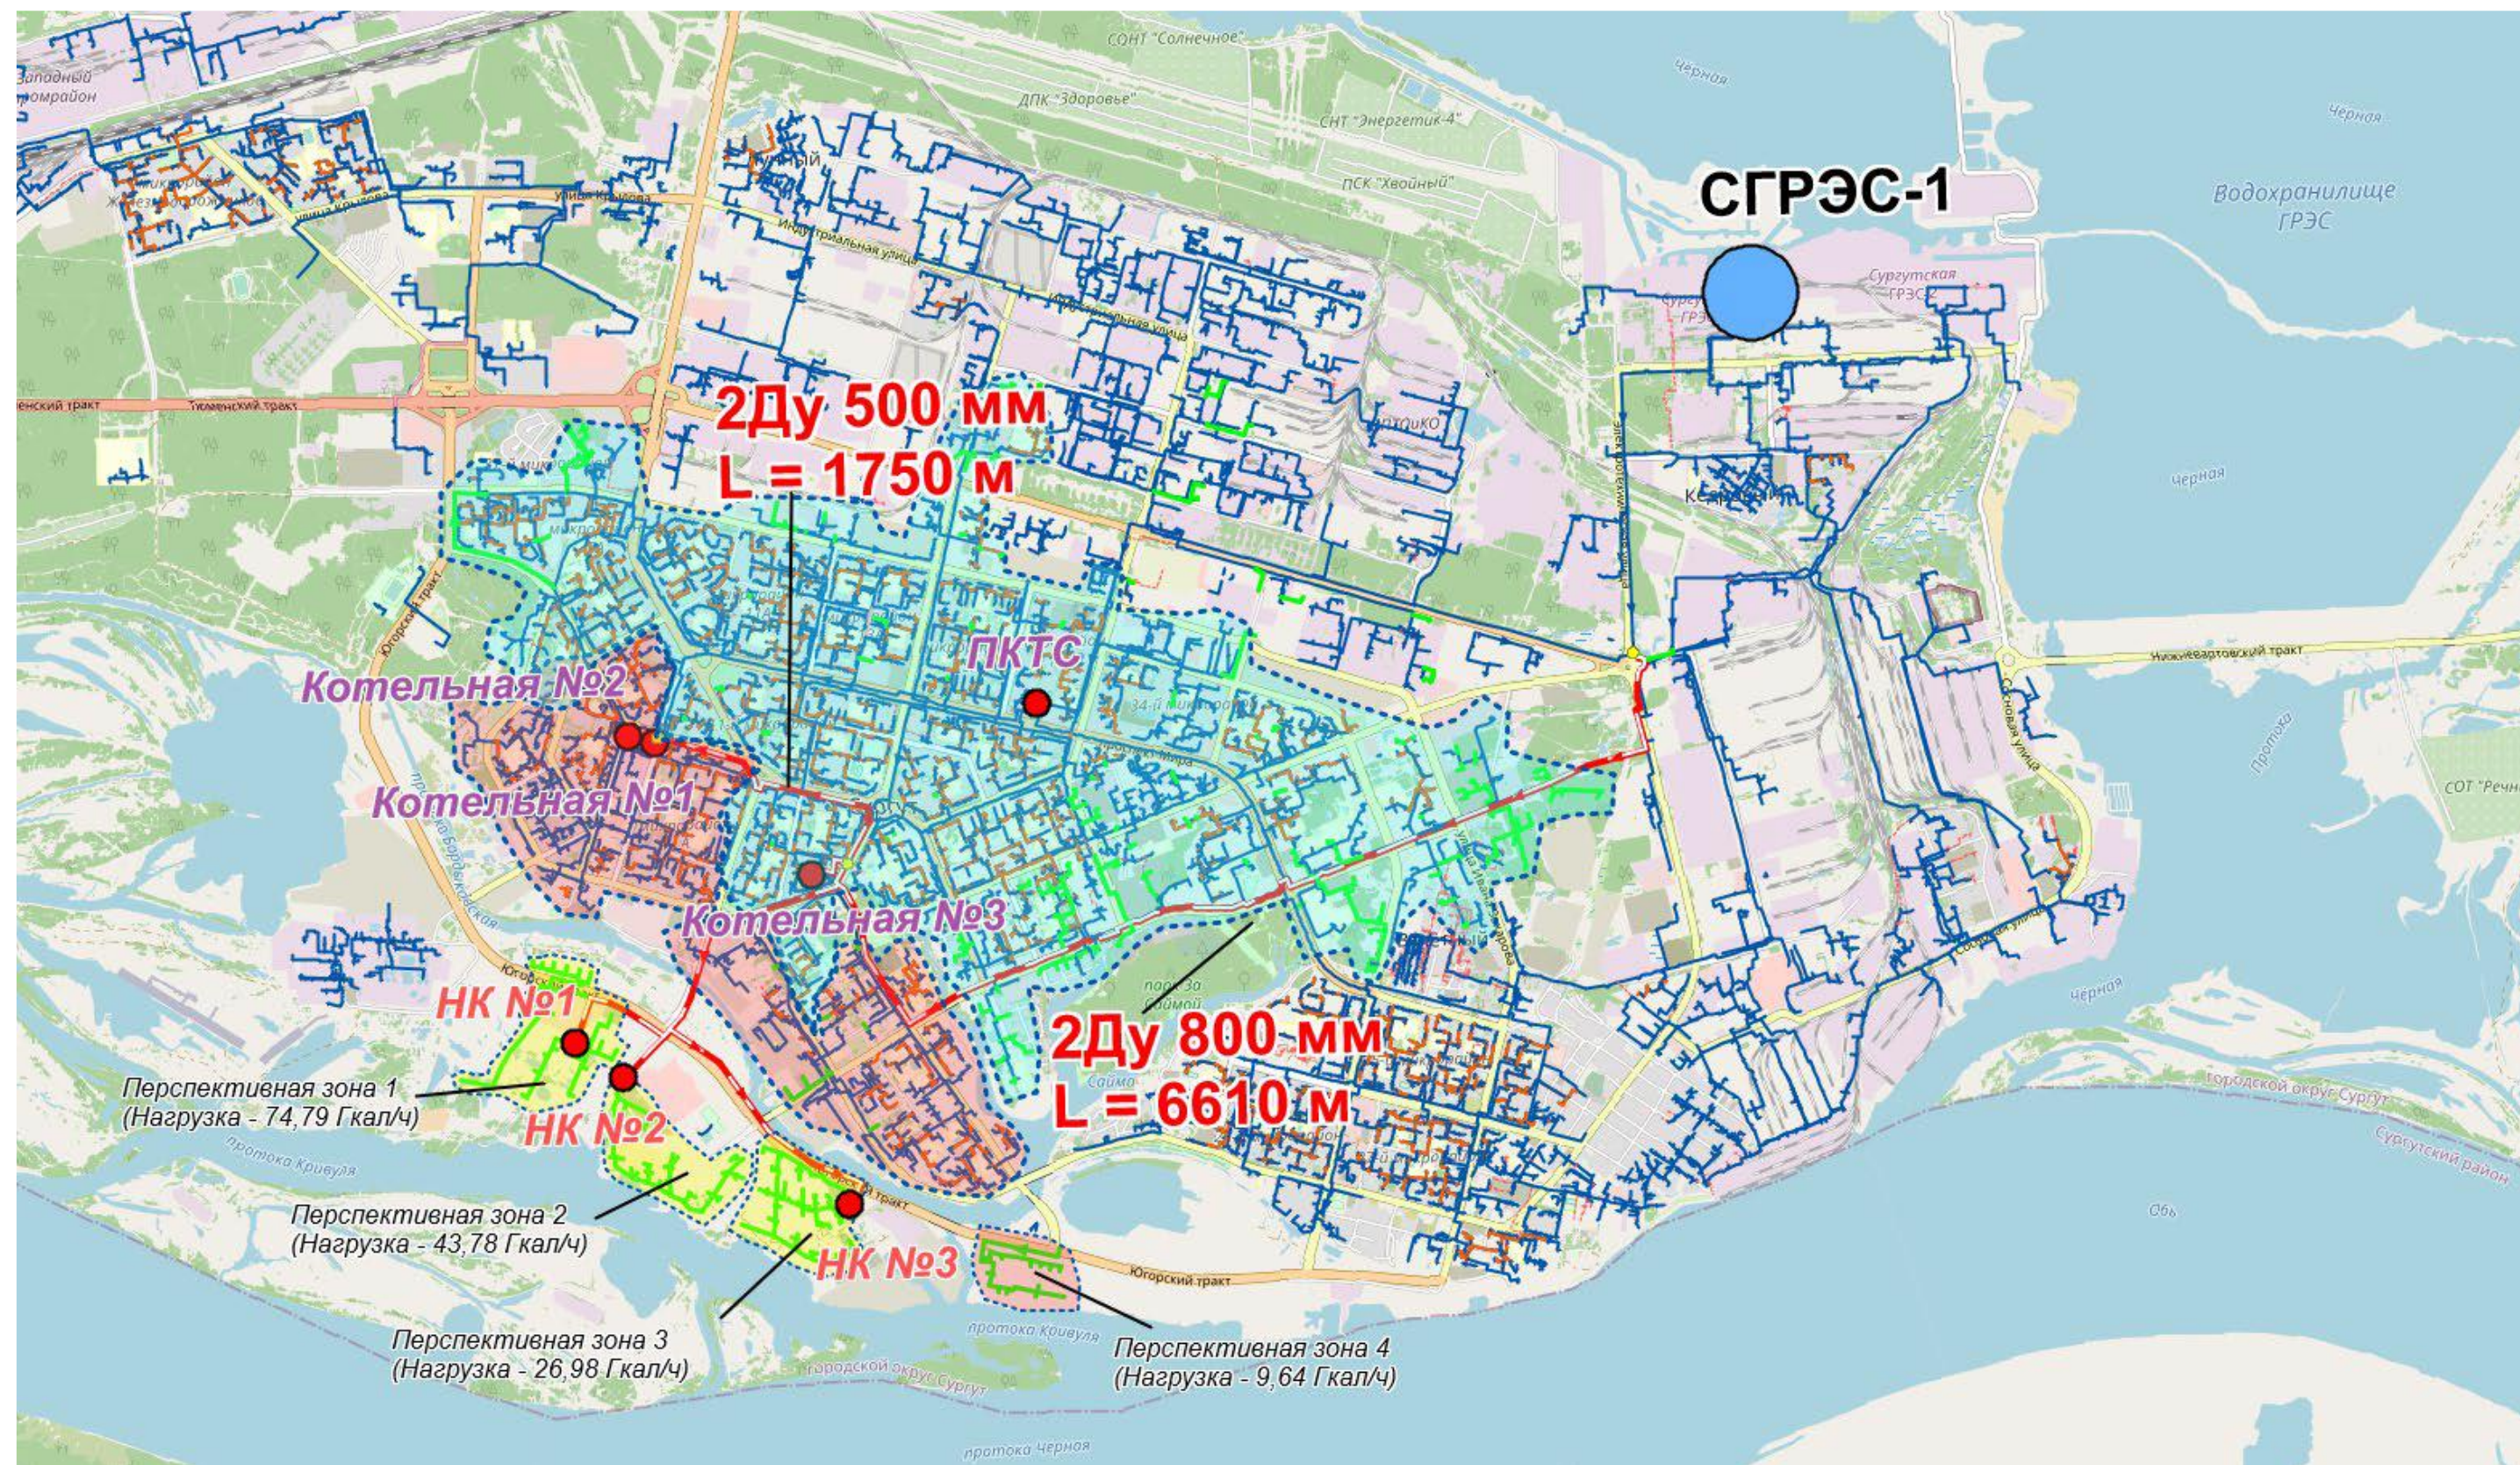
План-схема развития систем теплоснабжения по варианту №3
